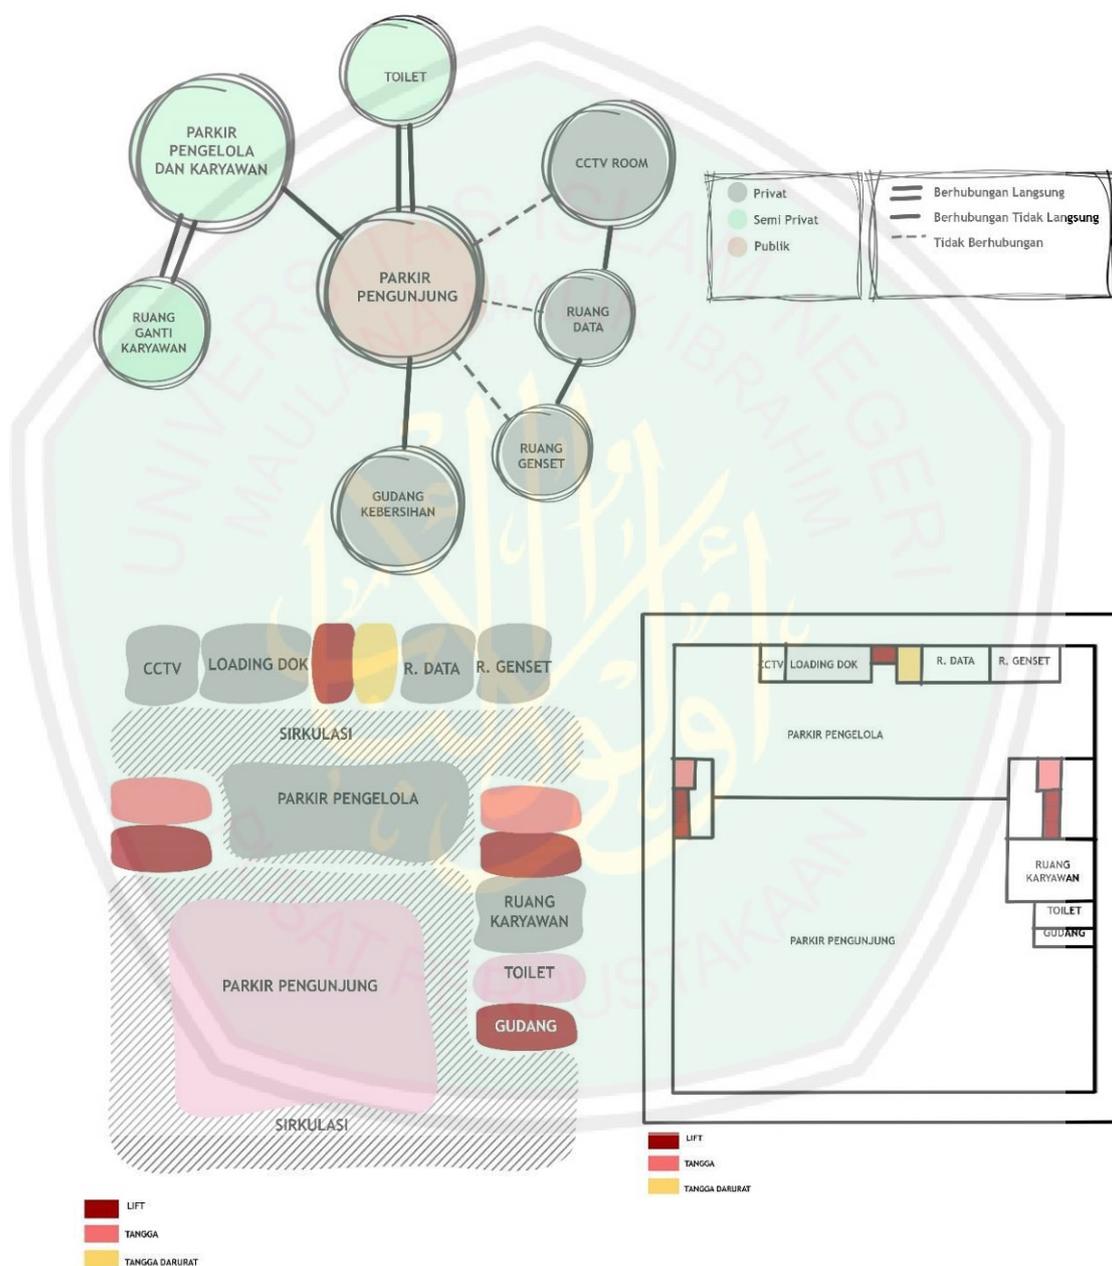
Hubungan Ruang dan Blok Plan Makro
